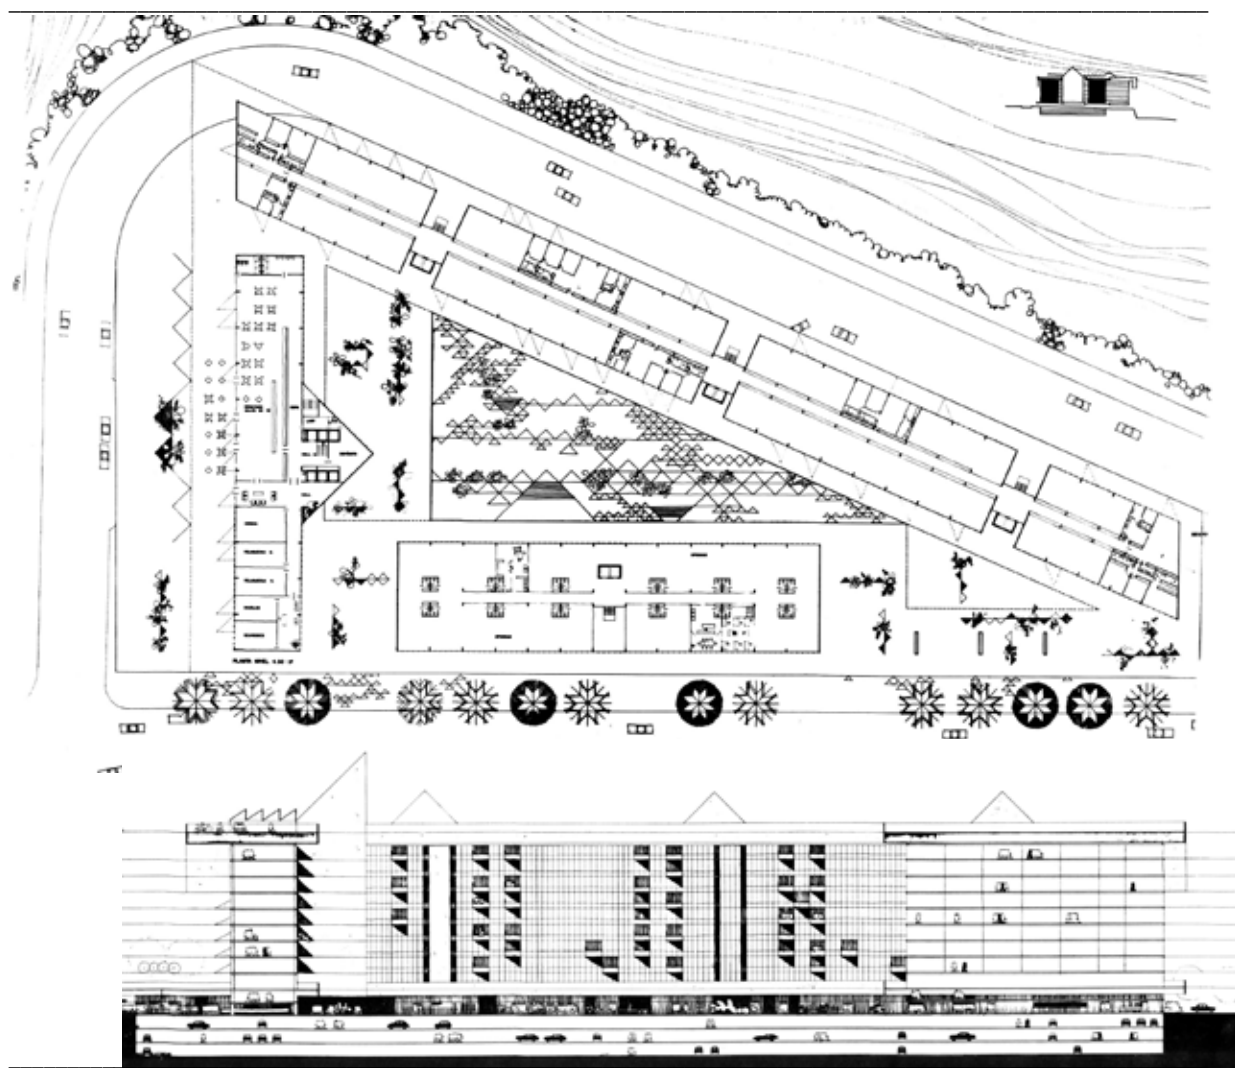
Complexo Turístico Euro Kurssal (projeto A); Luiz Forte Netto e José Maria Gandolfi; planta pavimento tipo. Três barras de dez pavimentos em torno de vazio central triangular. Uma das barras refere-se ao hotel, outra aos apartamentos para venda e, uma terceira para serviços e lazer. Fig. 696: Projeto A: corte longitudinal.
